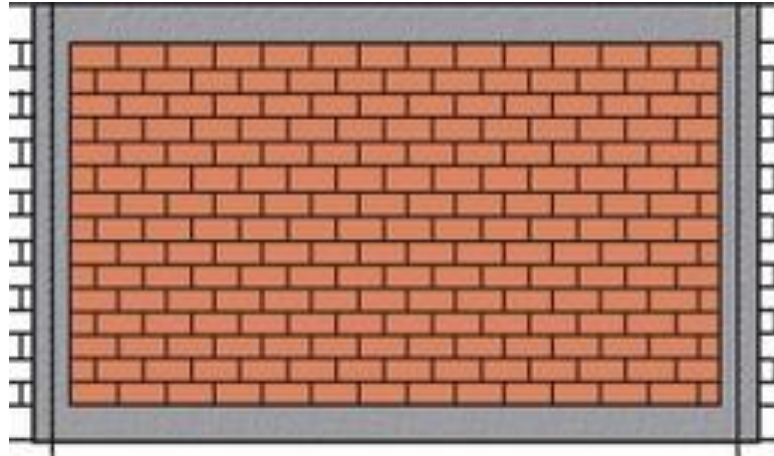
Muro confinado enmarcado por elementos de concreto armado
